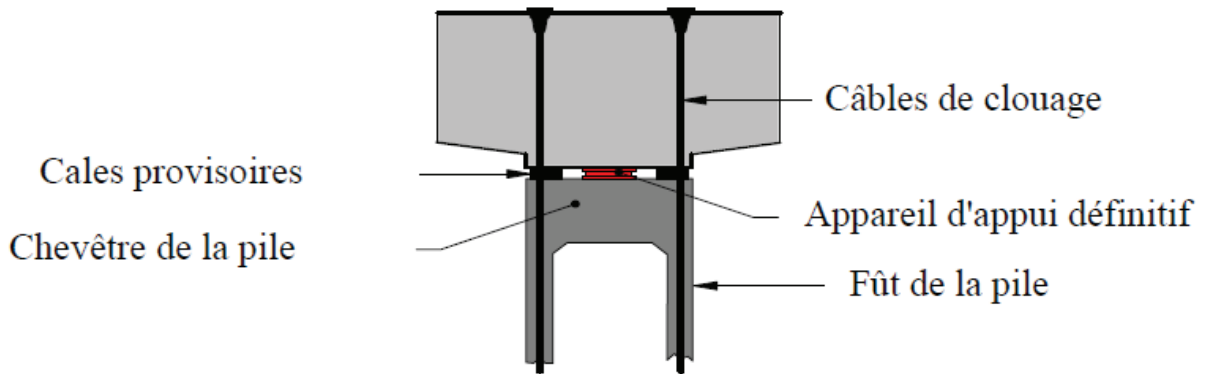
Schéma de clouage sur pile par câbles.
